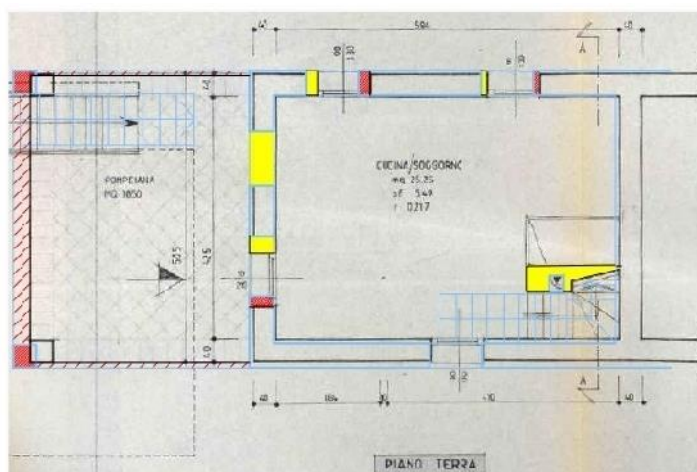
Comparazione con stato attuale (azzurro), difformità in rosso (costruzione) - giallo (demolizione) planimetrie non in scala
